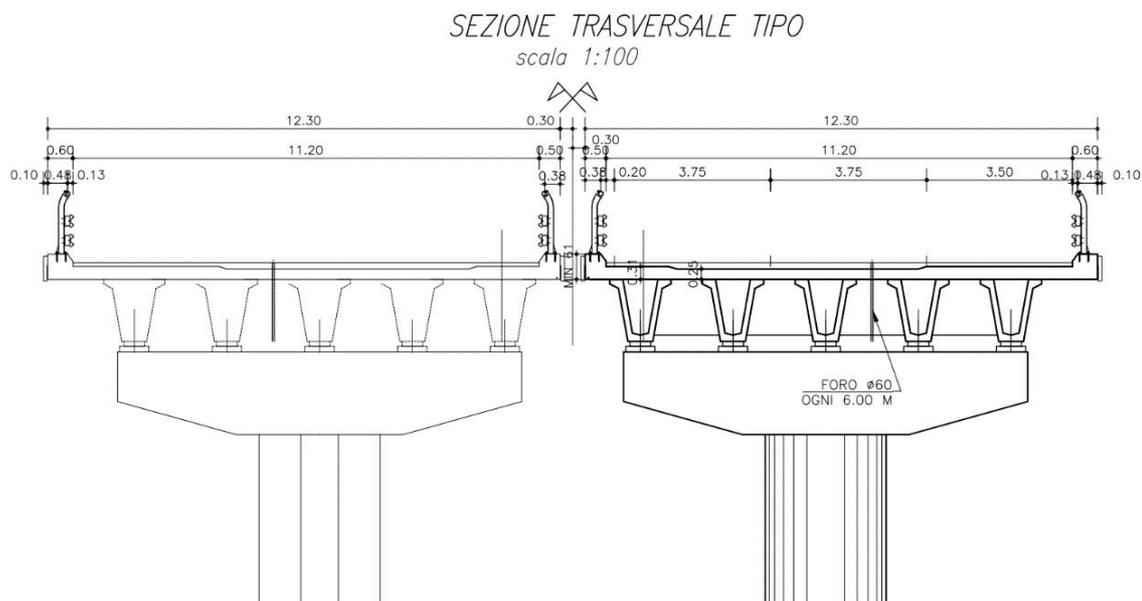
Sezione trasversale tipo – viadotto esistente (entrambe carreggiate) (Fonte: lista di controllo)
